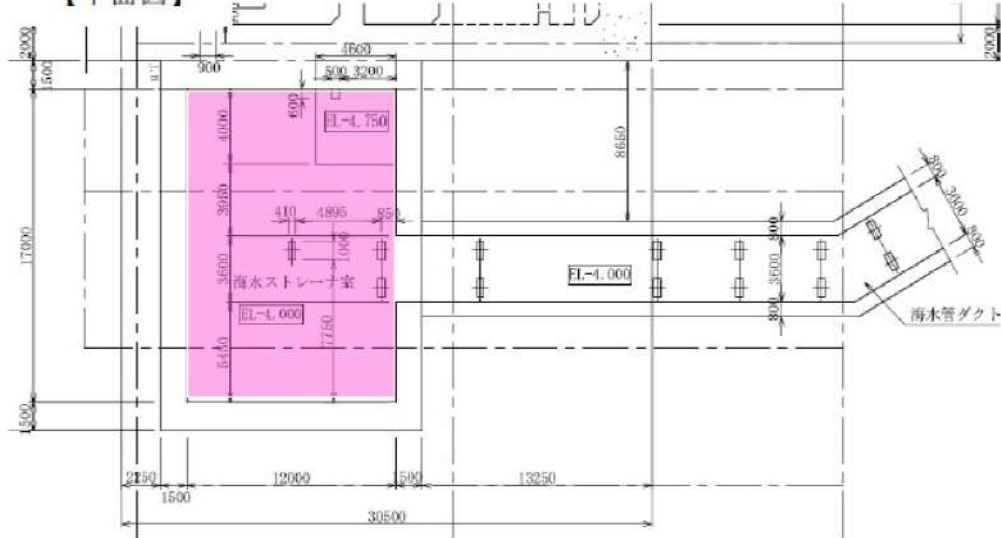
原子炉補機冷却海水管ダクト平面図及び断面図
